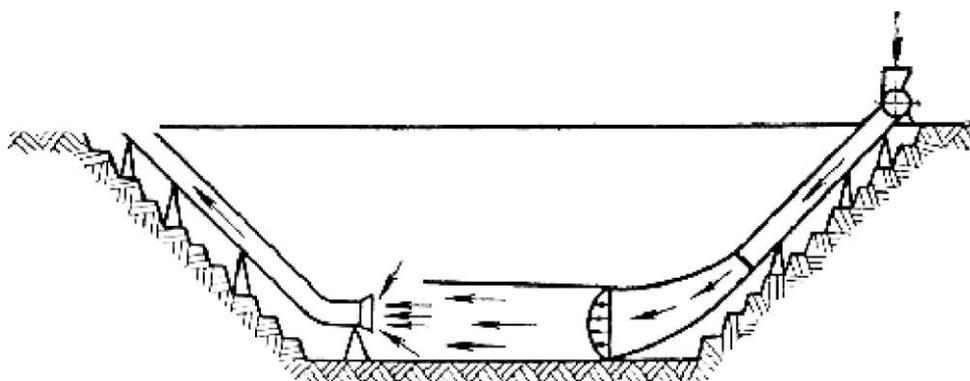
Схема нагнетательно-всасывающей вентиляции вентиляторными установками с применением трубопроводов
